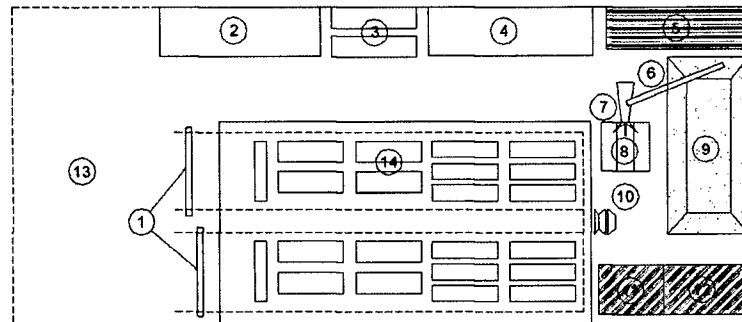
Esquema de la planta de prefabricados. Fuente:[4]
